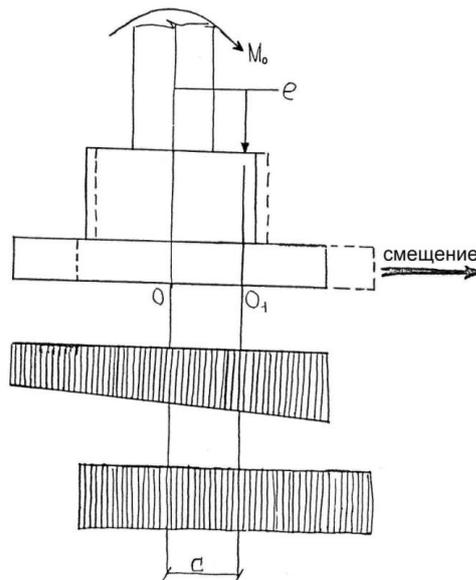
Схема фундамента при внецентренном нагружении:
